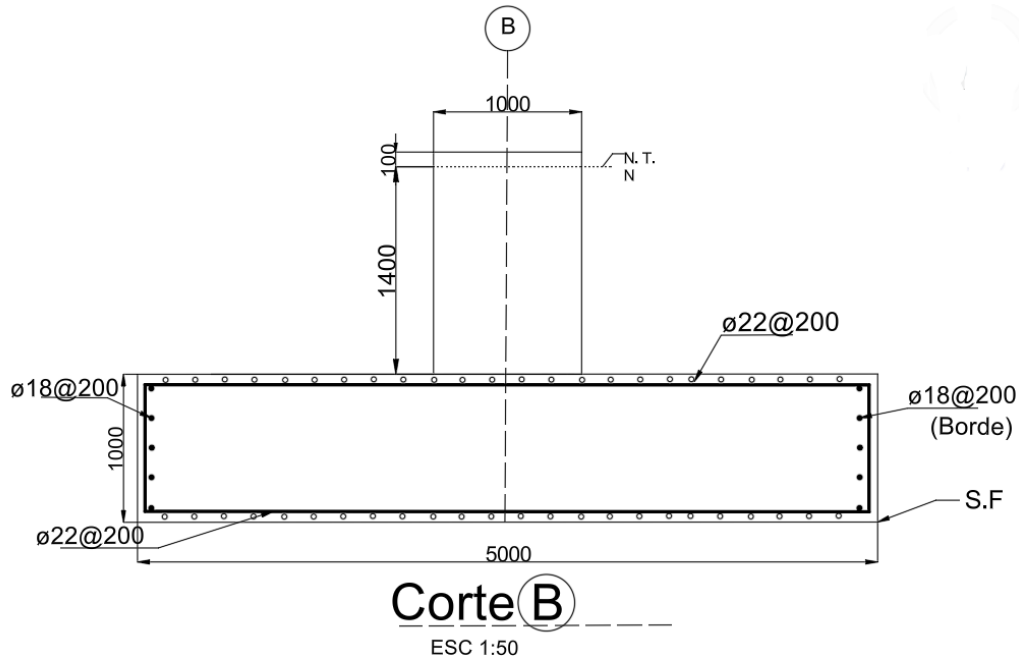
Corte B (Eje B) para la geometría y armadura de las zapatas
